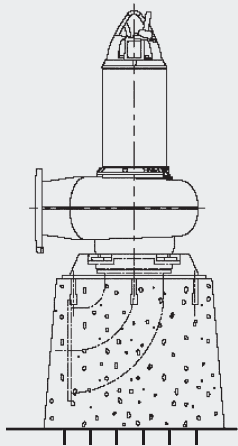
Вертикальный погружной канализационный насос Grundfos в вертикальной установке в сухом машинном зале на бетонном фундаменте, соединенном шпильками с полом.
